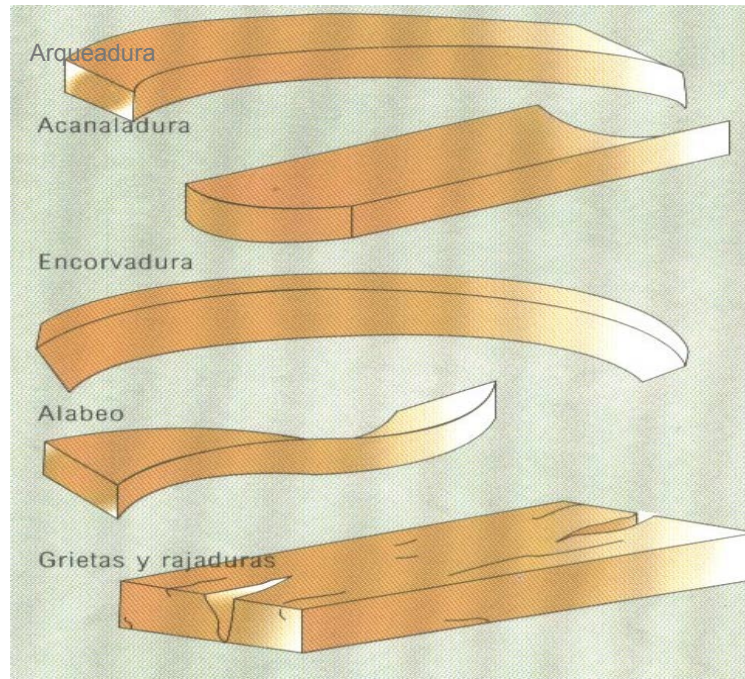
Torceduras y grietas en madera aserrada.
